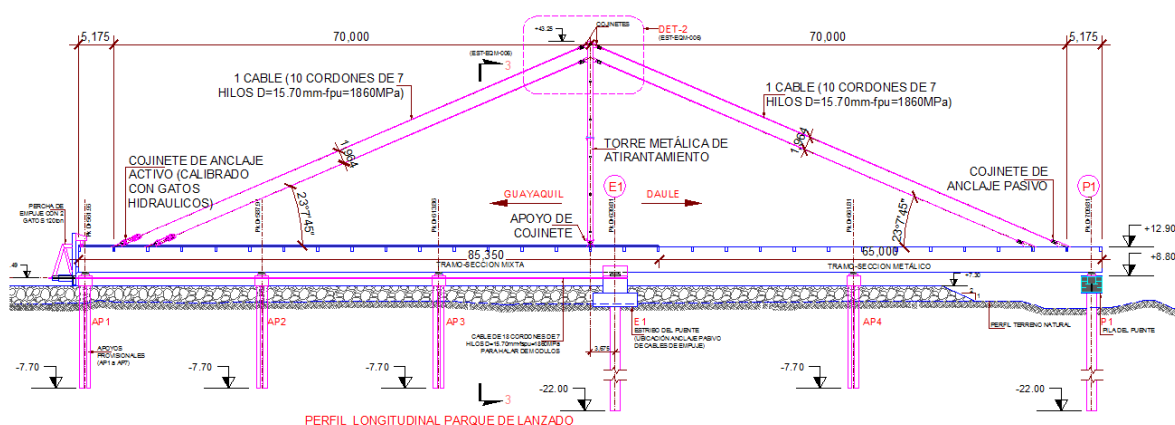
Elevación del parque de lanzamiento de la superestructura (Fuente: Elaboración propia)
